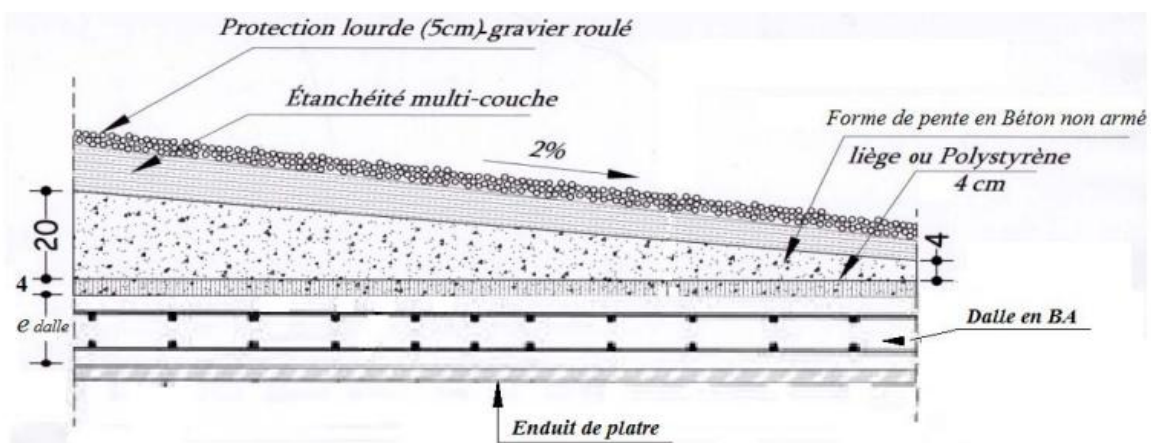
Détails d'un plancher en dalle pleine (plancher terrasse inaccessible)
